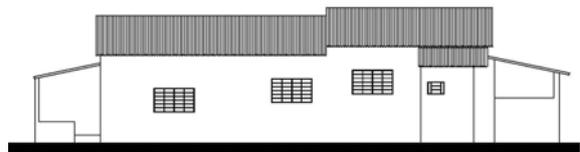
Fachada Nordeste (Acervo PROAU/FAU/UnB).
